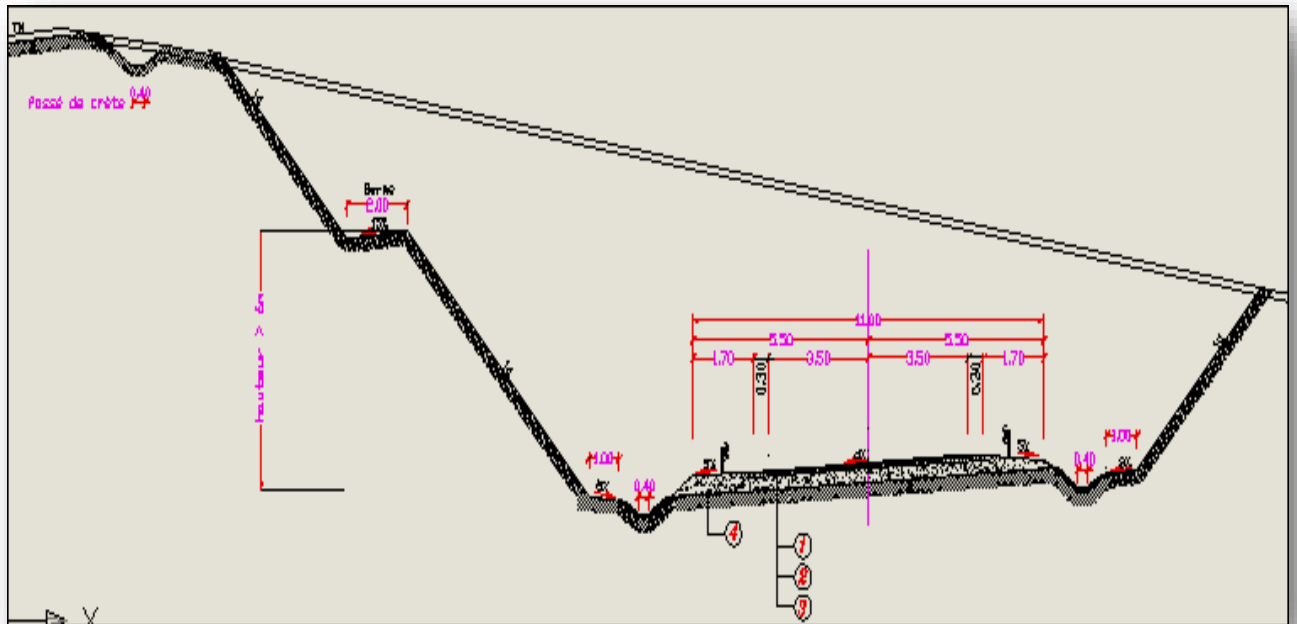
13 : profil en travers type en déblai de la RN 94.
